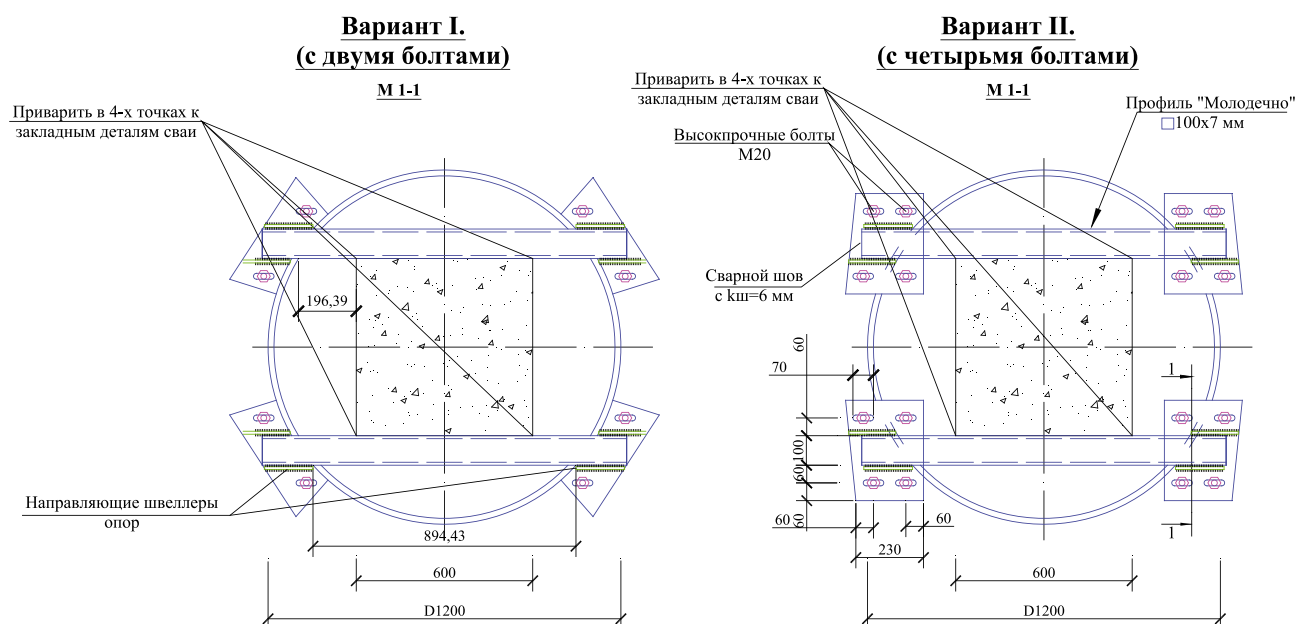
Варианты креплений выключающихся элементов из металлических балок к железобетонным сваям и обсадным трубам
